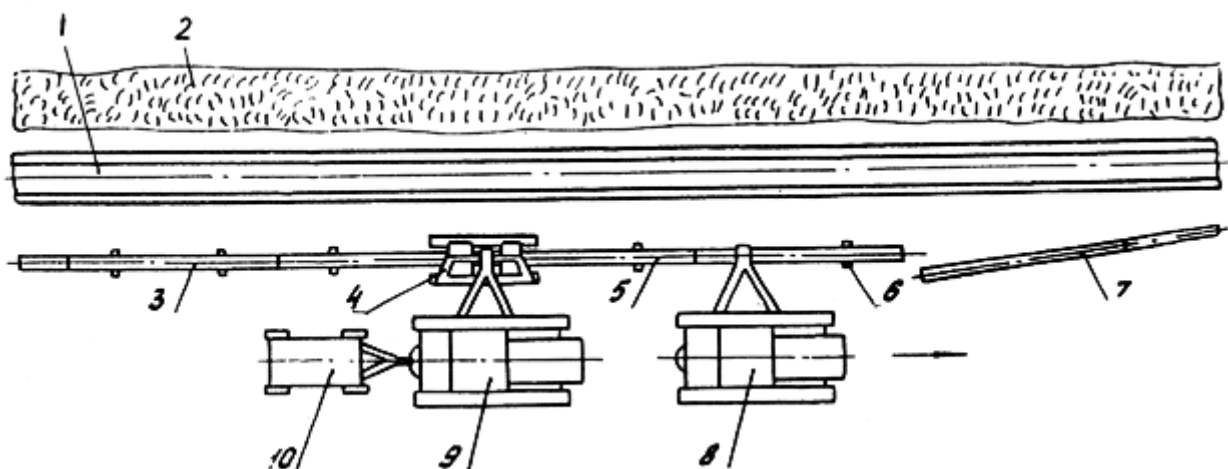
Схема сварки трубопровода в непрерывную нитку с использованием одного центратора и грузоподъемной техники:
